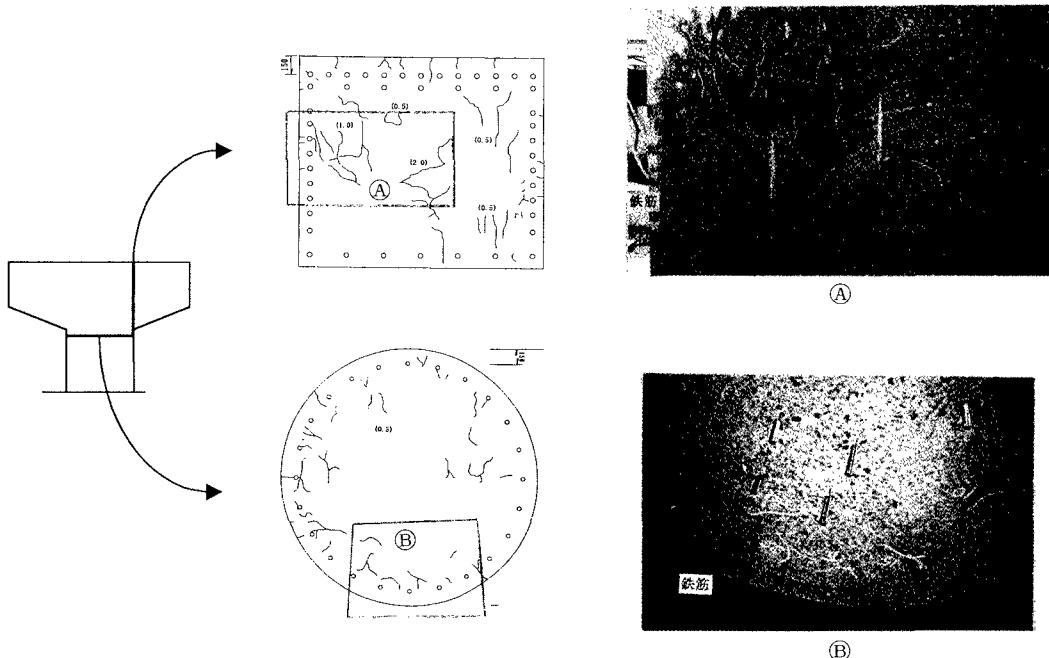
梁・柱部の切断面と内部ひび割れ
